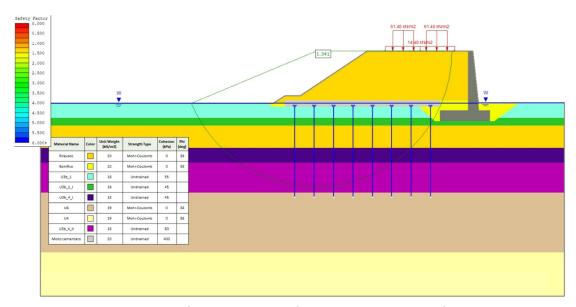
Sezione B - Analisi SLU in campo statico DA1C2
